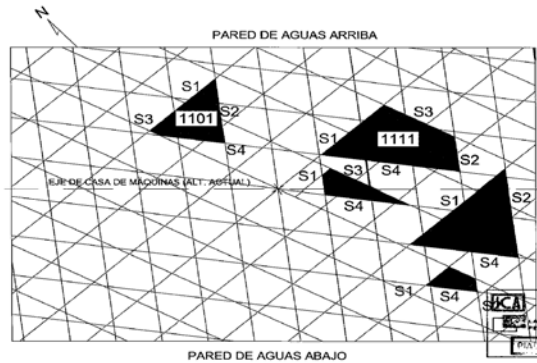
Planta esquemática, indica la granulometría de los bloques que se forman en la bóveda de la caverna de casa de máquinas.
